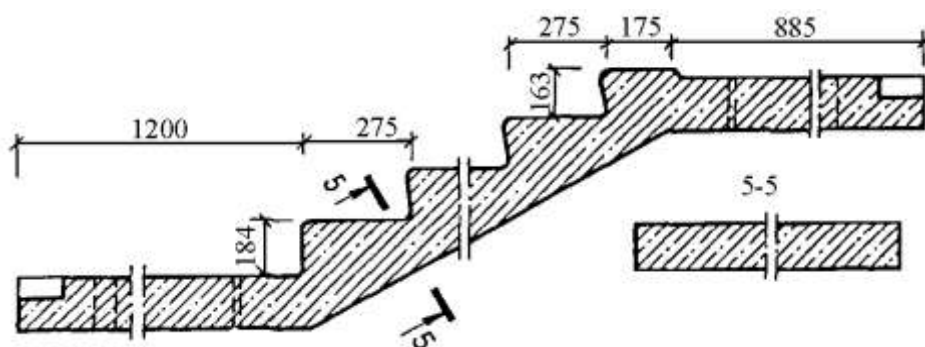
Конструктивные решения железобетонных сборных лестниц из крупных элементов
